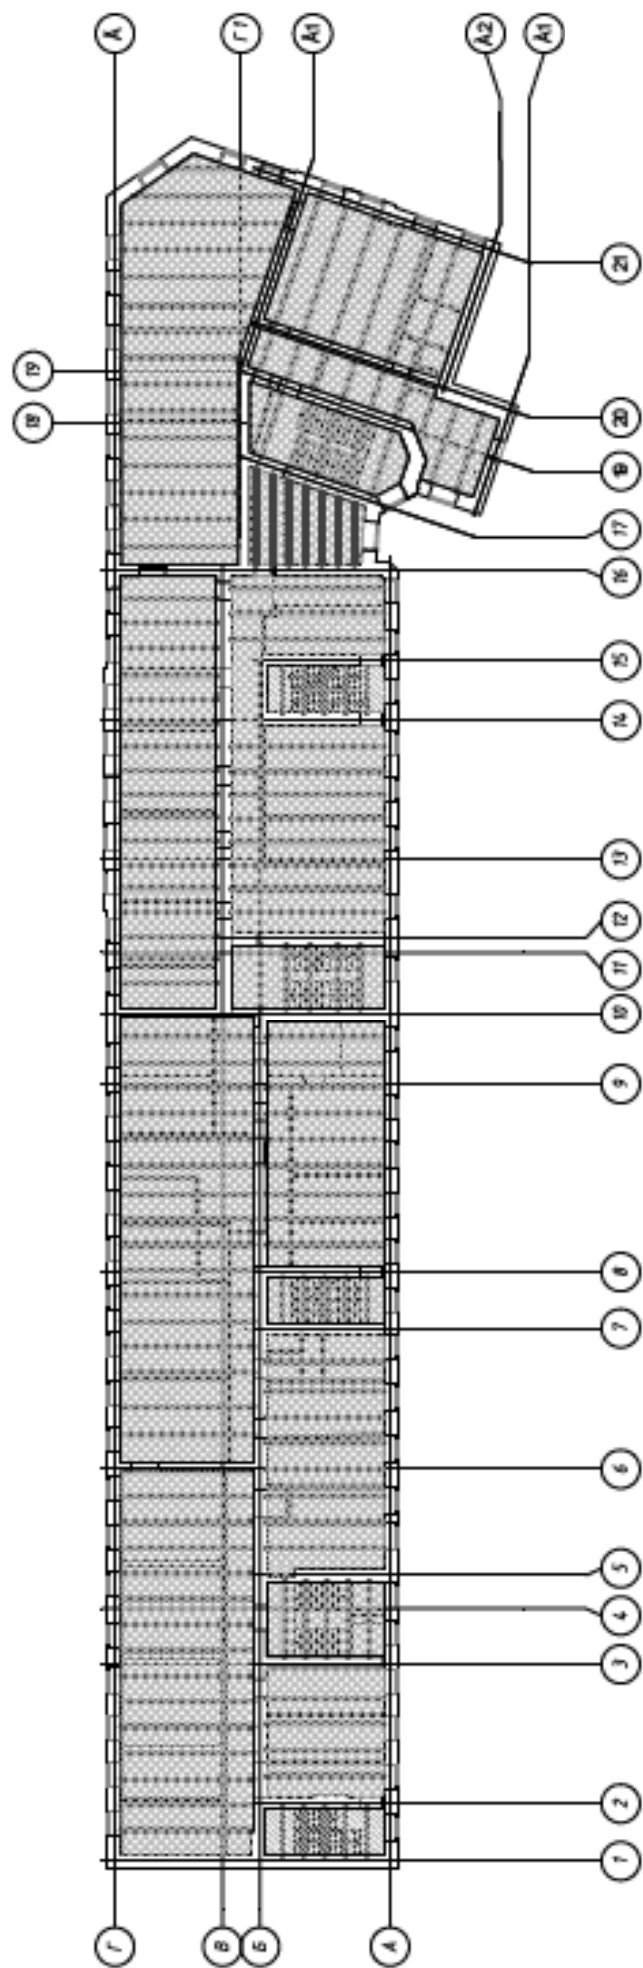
Схема расположения балок 4-го этажа (шаг балок 1000-1200мм)
